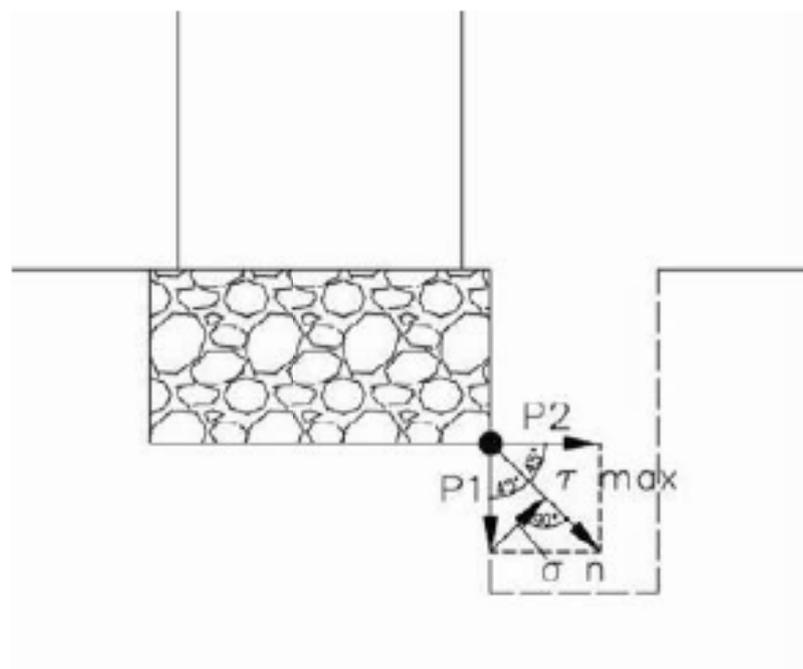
Расчетная схема к определению максимальных касательных напряжений и сопротивляемости грунтов основания сдвигу под краем фундамента
